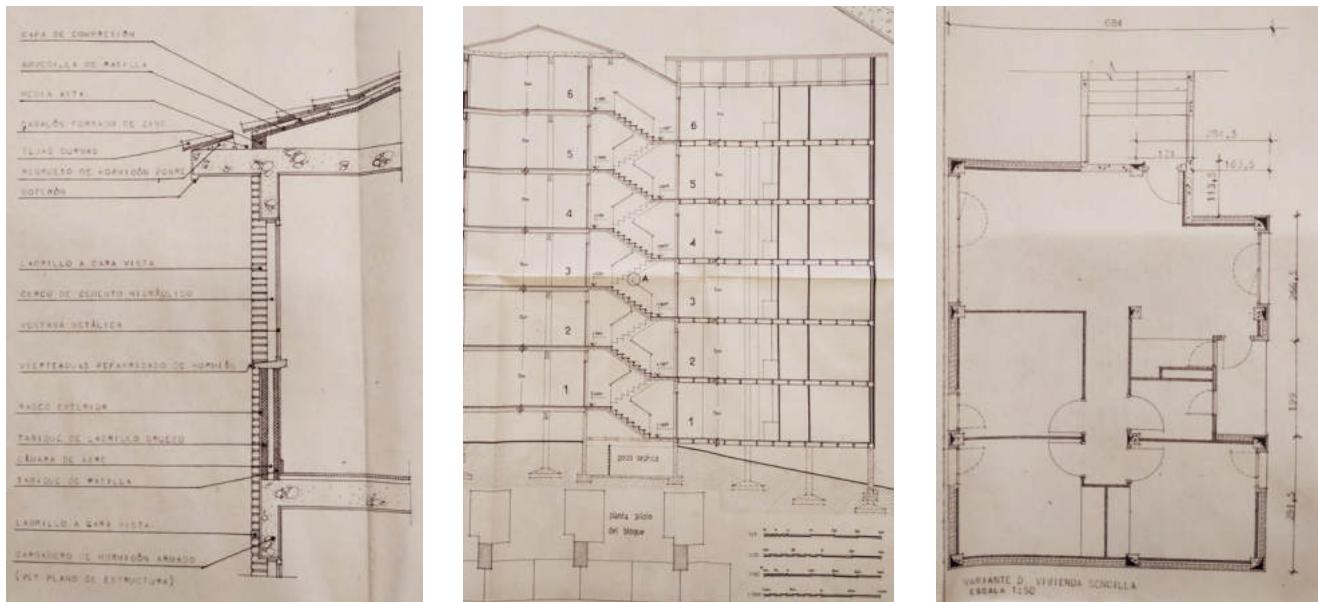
Detalle, alzado y planta de vivienda residencial tipo IV en Otxarkoaga. Fuente: Archivo Municipal de Bilbao
